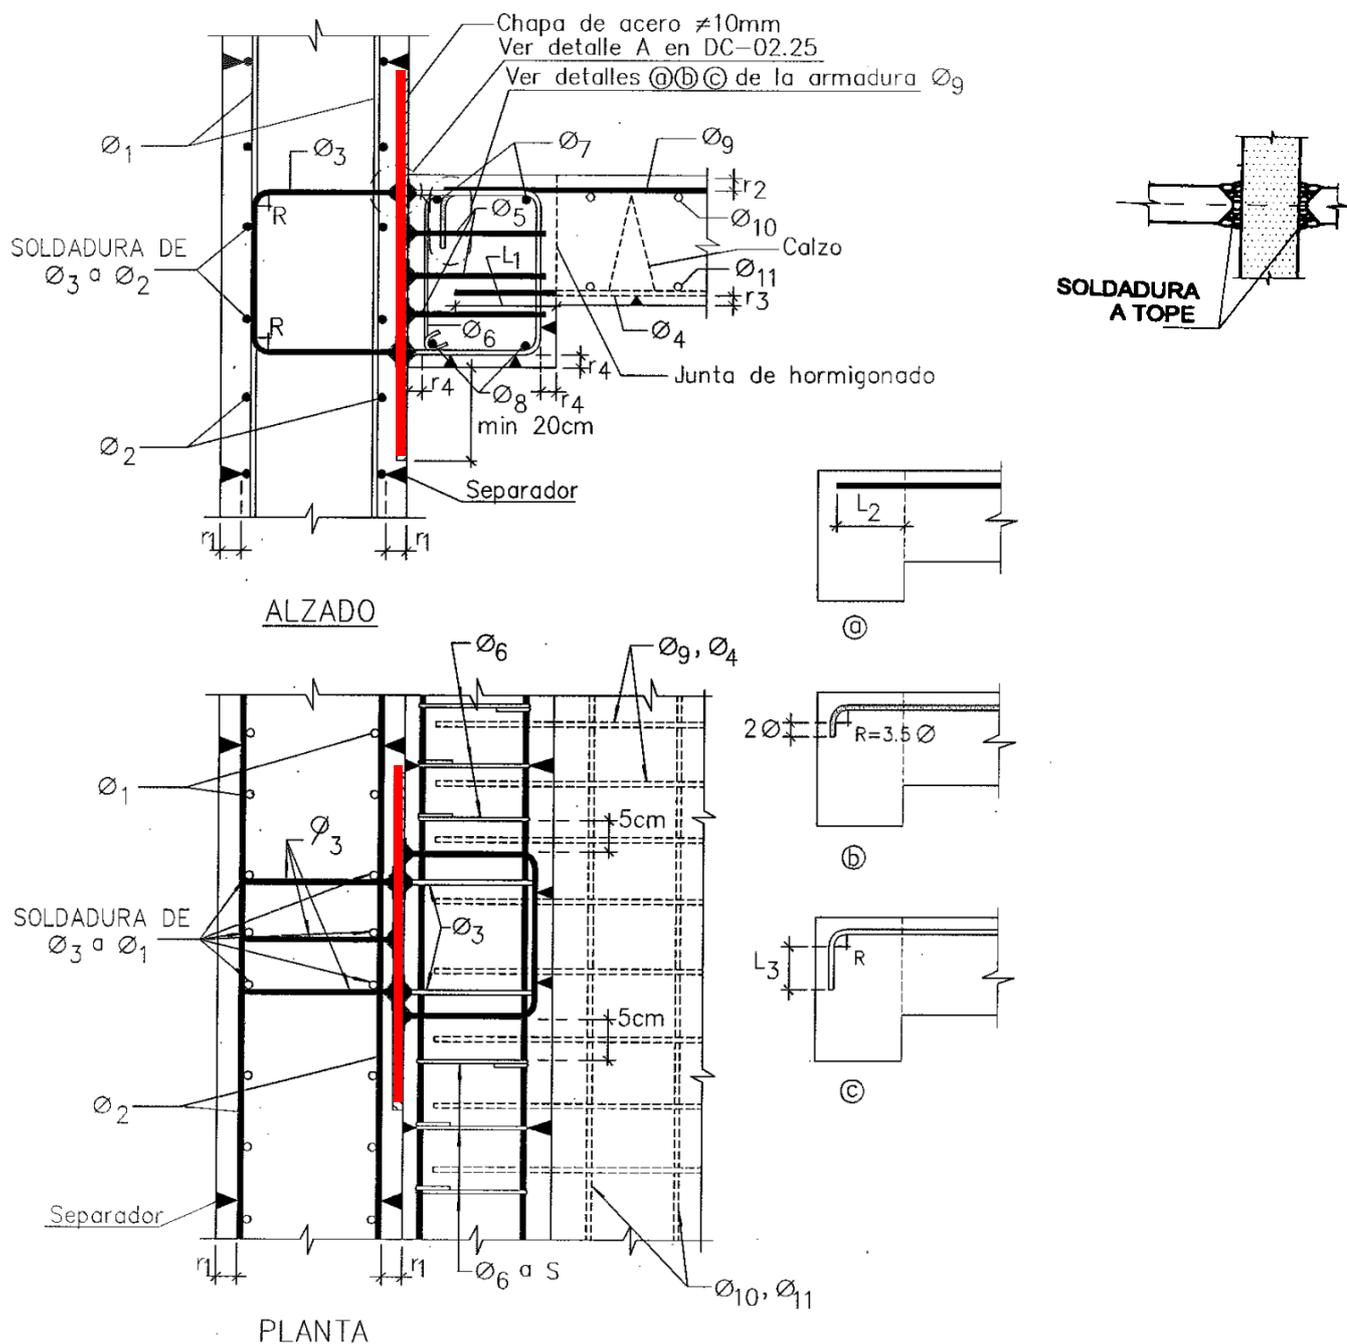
Detalle 2: Chapa de acero embebida en muro pantalla (Detalles Constructivos J. Calavera, 1993)
